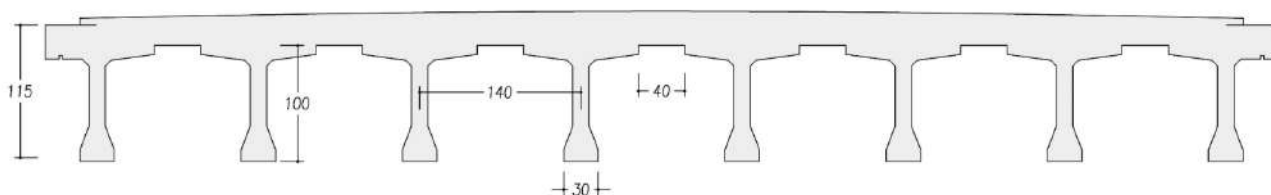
SEZIONE TRASVERSALE DELL'IMPALCATO
